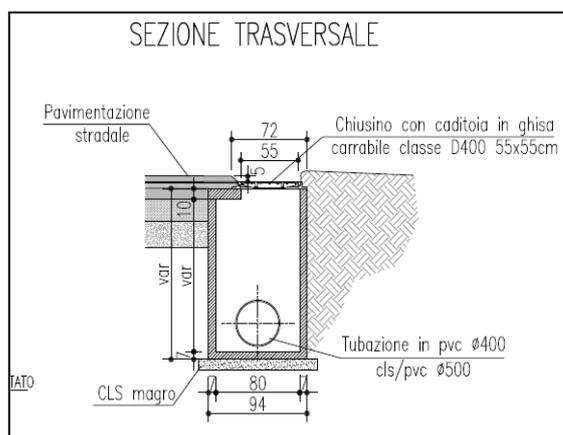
Pozzetto caditoia in cunetta rettangolare.
